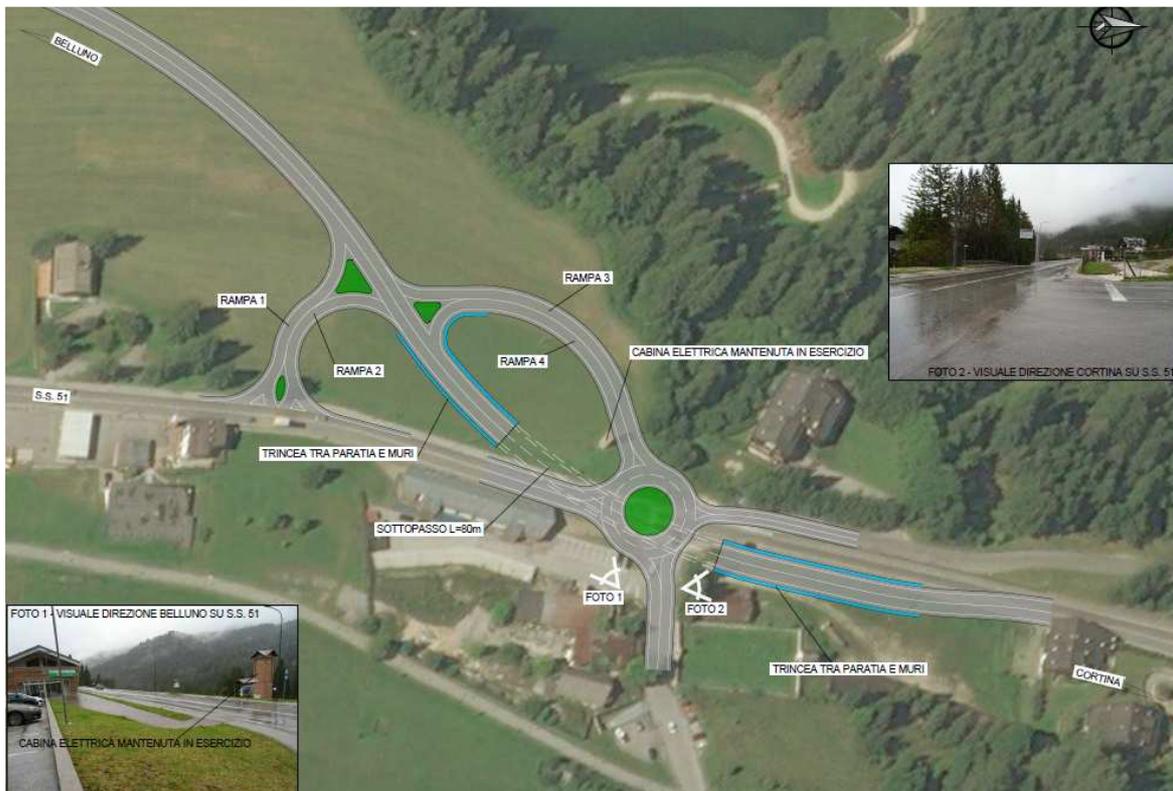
La soluzione 2C-C per lo svincolo lato Cortina (studiata durante il progetto definitivo) N.B. La planimetria è ruotata di 180° rispetto alle precedenti
